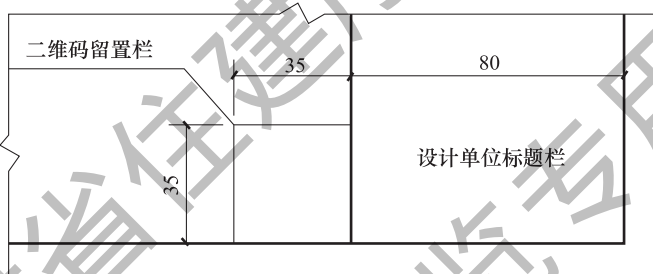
二维码留置栏布置图二(单位:mm)
